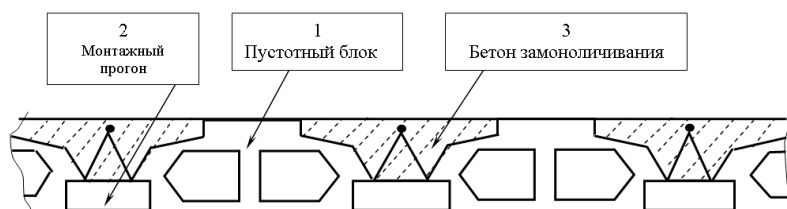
Поперечный разрез сборно-монокристаллического перекрытия типа 2К
